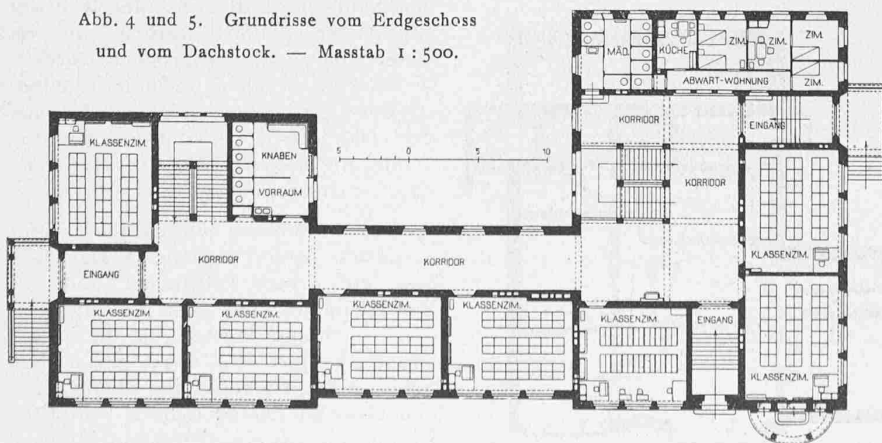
und 5. Grundrisse vom Erdgeschoss und vom Dachstock. — Masstab 1 : 500.
